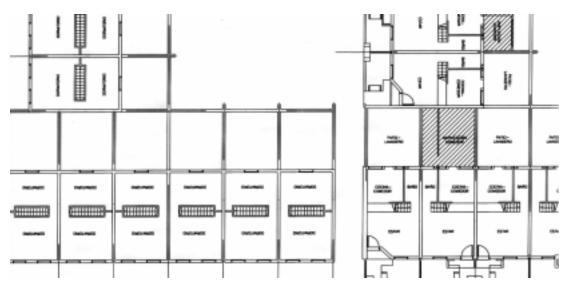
PLANTA BAJA Y ALTA. SECTOR TIRA VIVIENDAS
